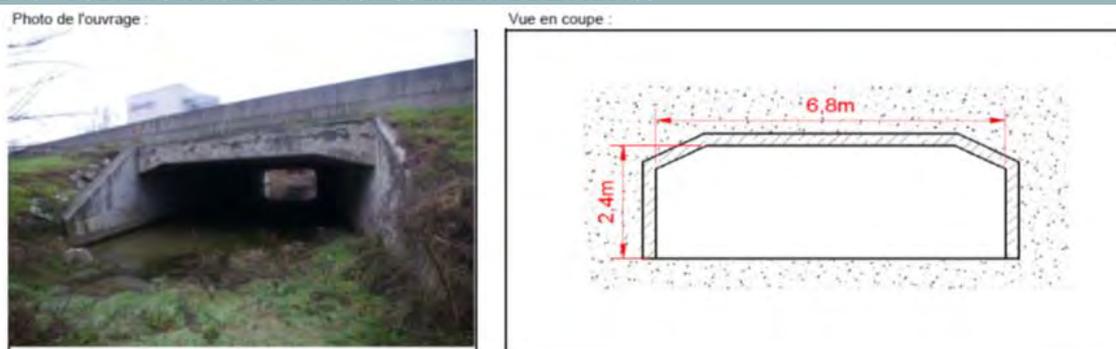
OUVRAGE ET COUPE DE L'OUVRAGE OH5B
